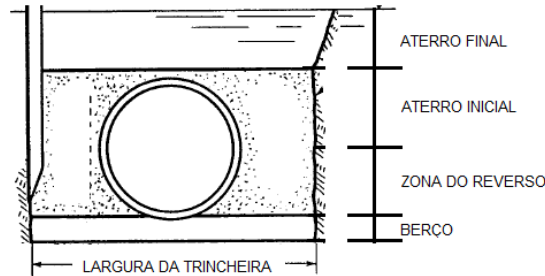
Elementos constituintes de uma instalação típica (Modificado de Rubio, 2008).
